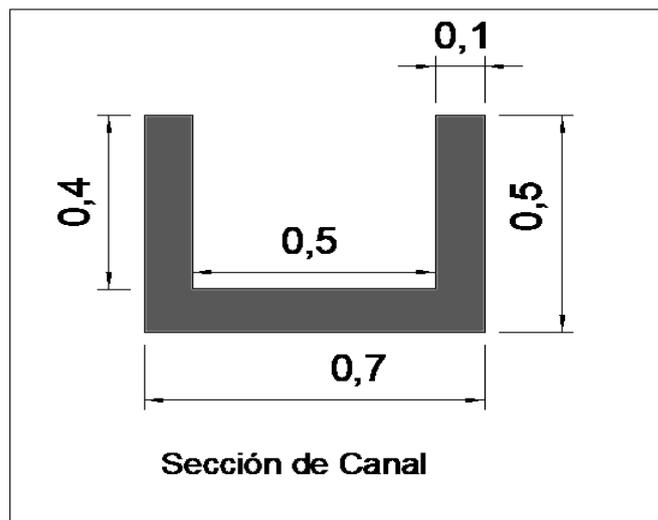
Sección transversal tipo rectangular de canal Tacarpo
